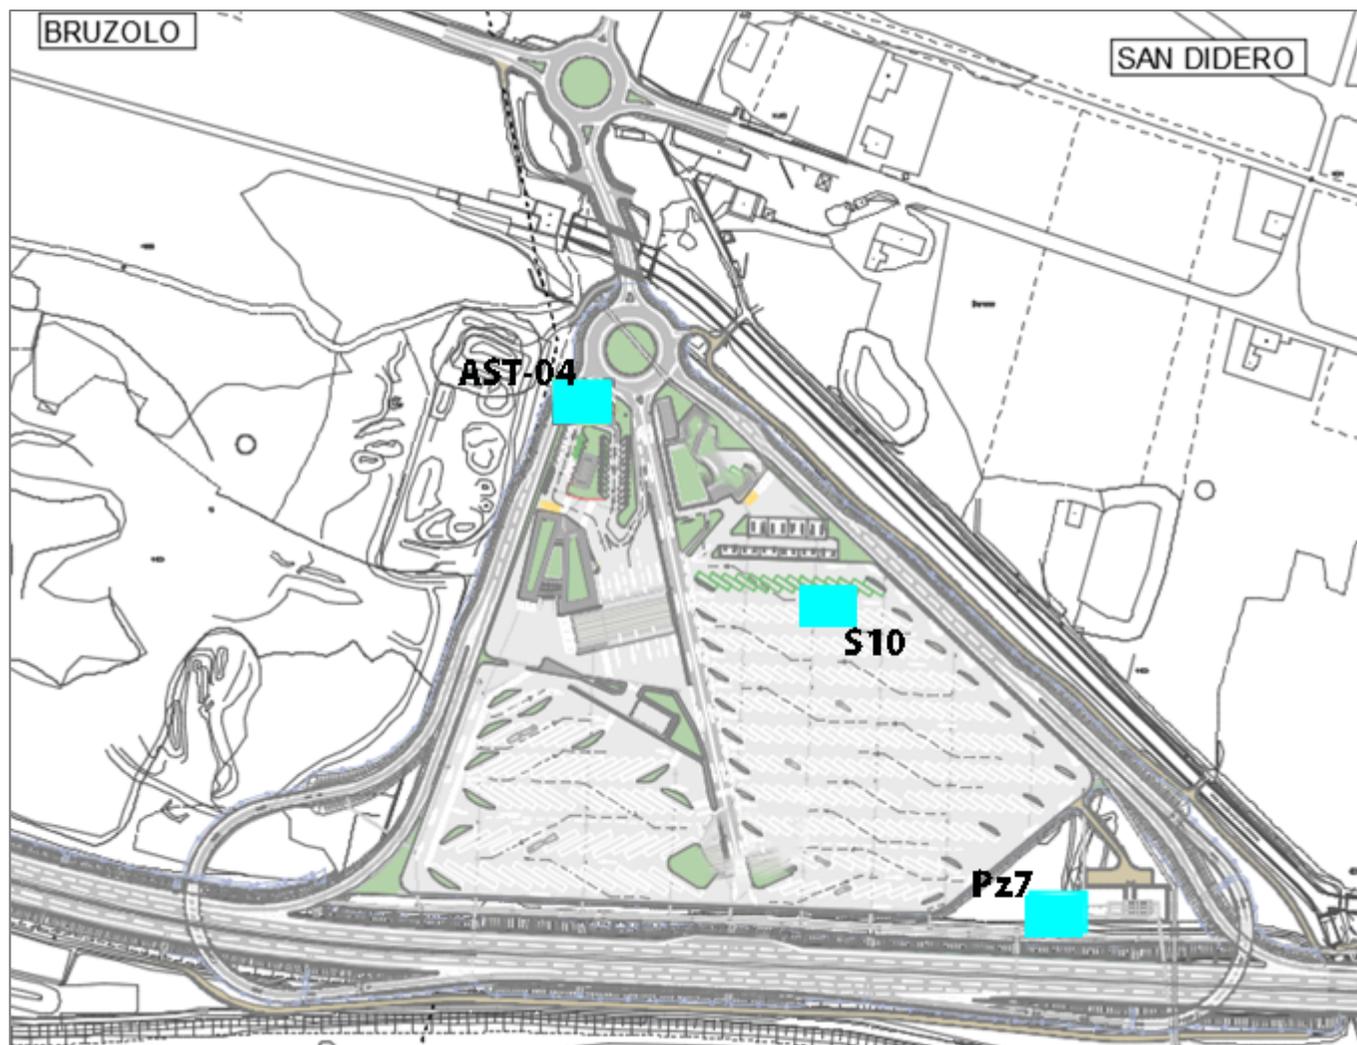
Localizzazione dei piezometri oggetto di monitoraggio con sovrapposizione del layout di progetto
